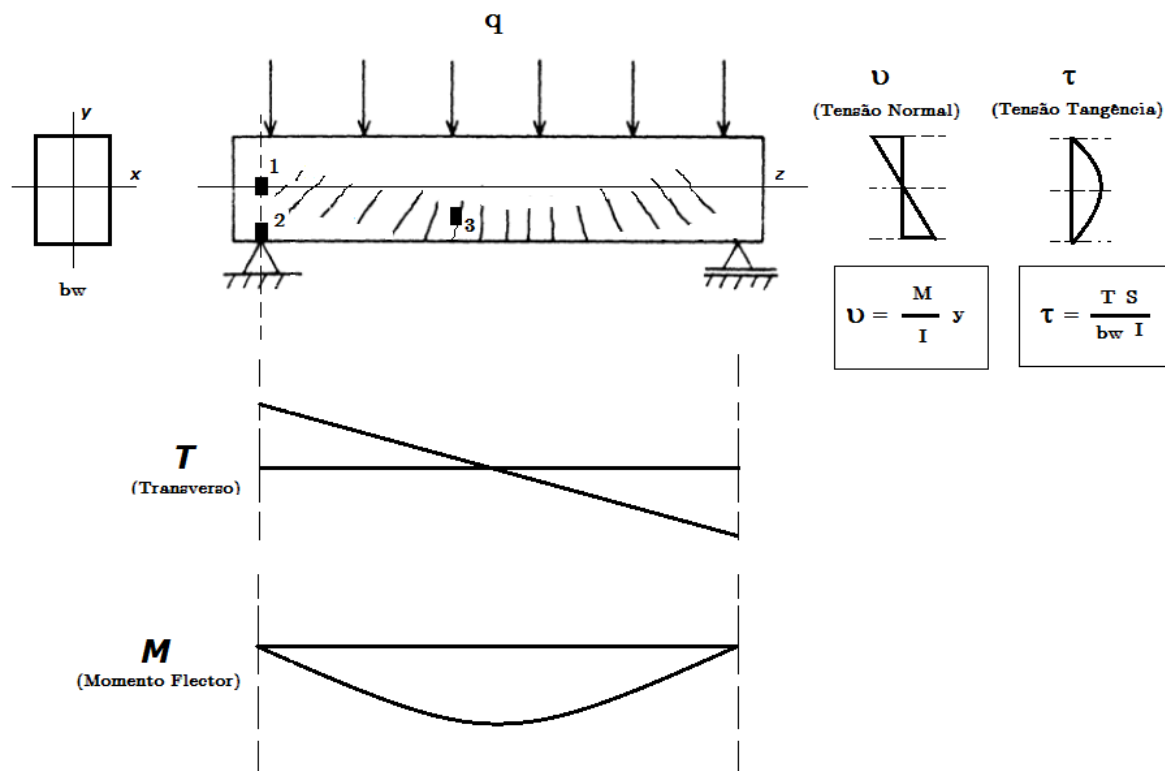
Variação de esforços e tensões numa viga simplesmente apoiada de betão armado
